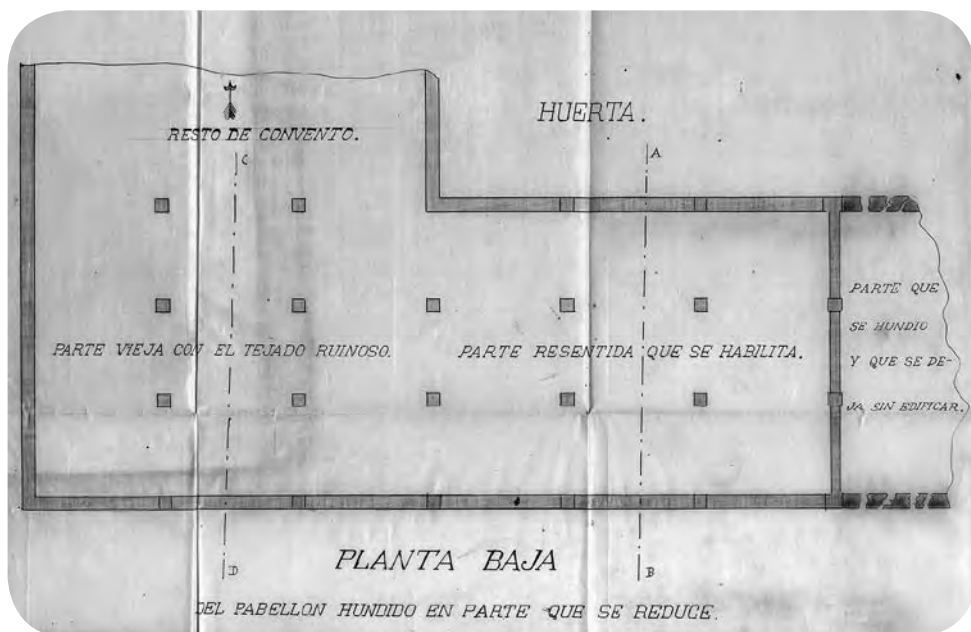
Planta. Proyecto de reparación del convento de la Concepción de Nuestra Señora, arquitecto Elías Ballespín, 1882. Plano A.D.T.
